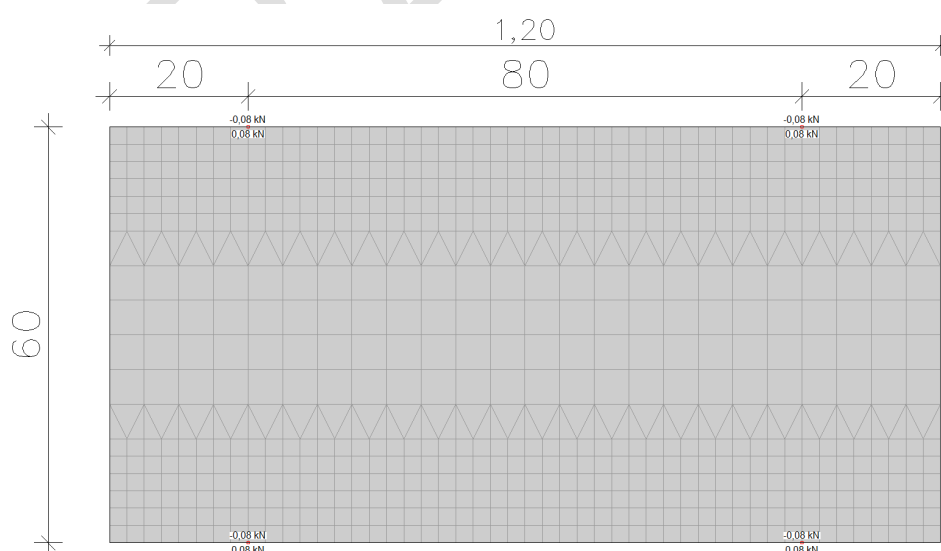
Statisches System Lichtbetonelemente, inkl. Auflagerkraft Rz
